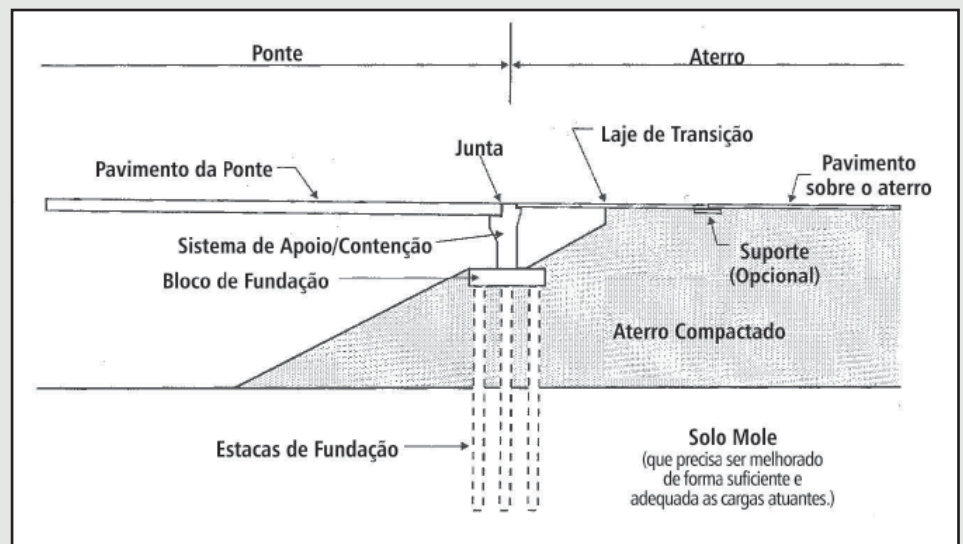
Detalhes de um aterro de encontro e a ponte.
